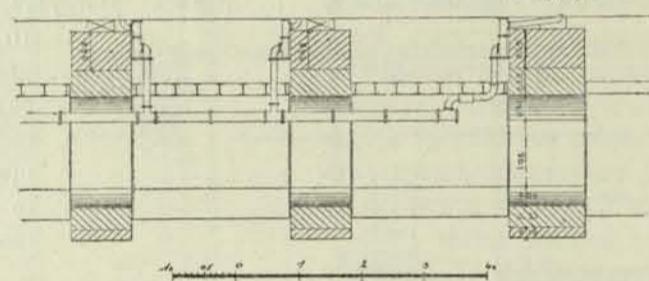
Планъ поперечн. багажн. тоннеля.
